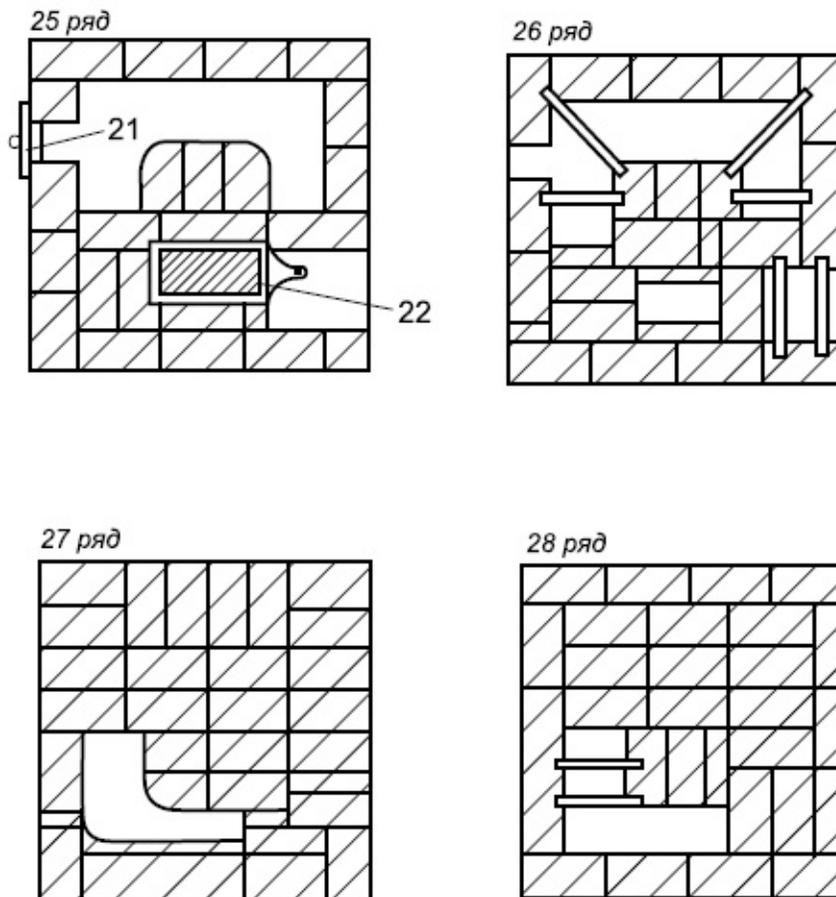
Кладка отопительно-варочной печи с камином (окончание): 21 – дверка чистки; 22 – задвижка камина
